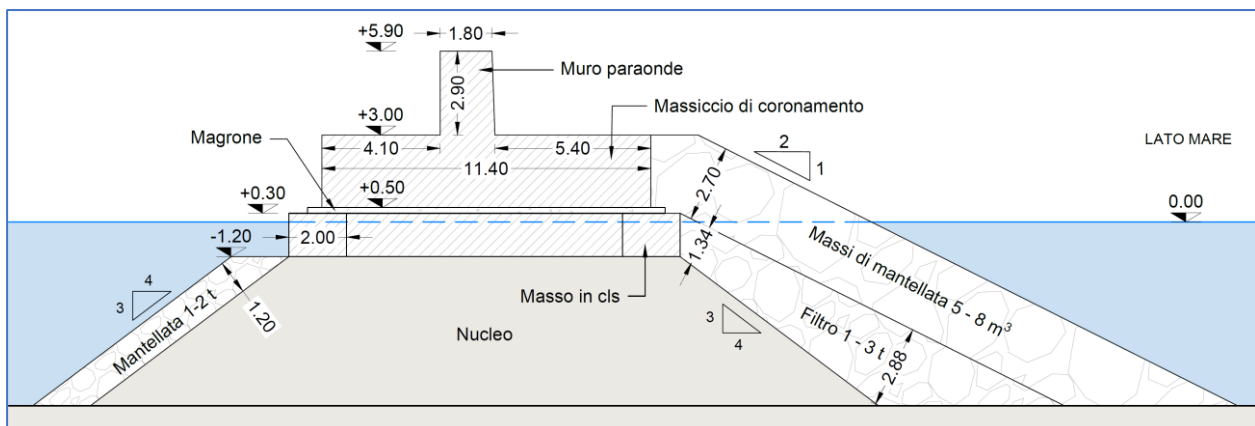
Schematizzazione della sezione tipo “a gettata” dell’attuale Vecchia Diga Nord del Porto di Ortona
